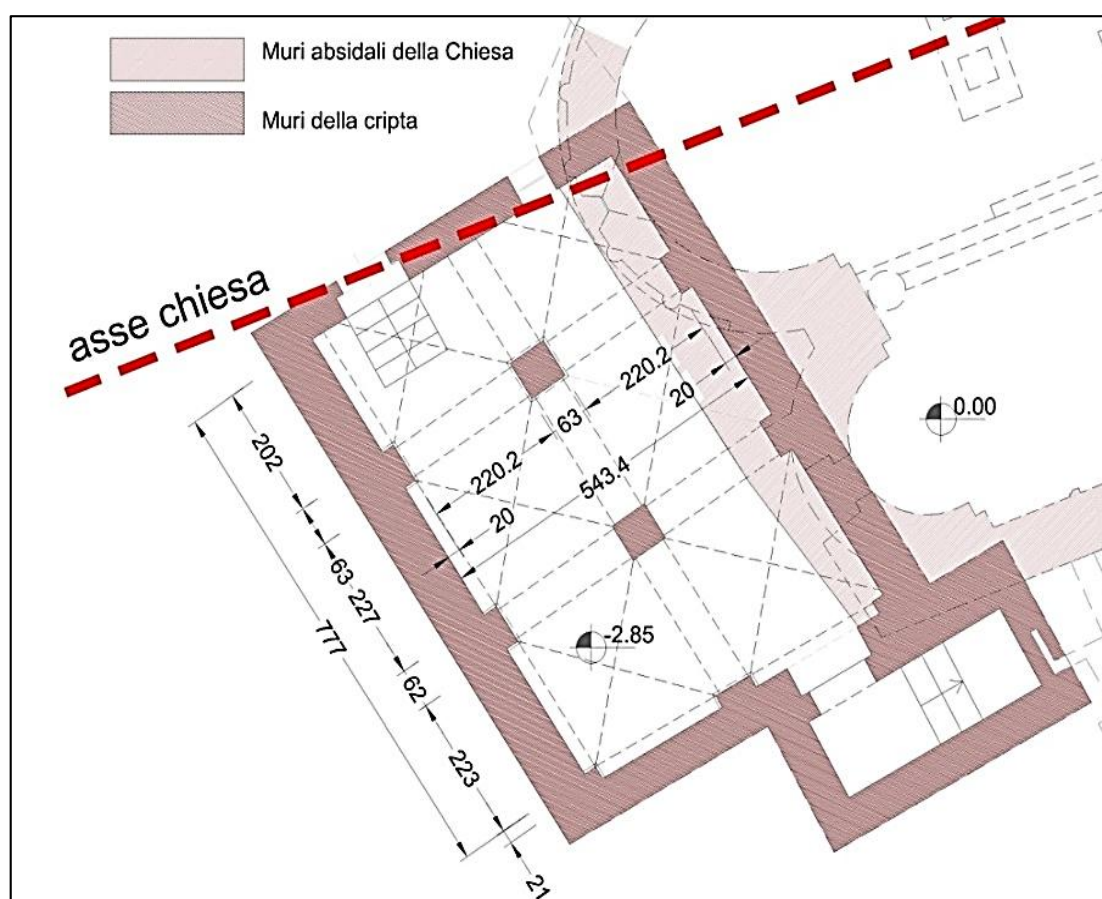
Pianta dell'attuale cripta (un tempo Chiesetta bizantina) rispetto al muro absidale della sovrastante chiesa
